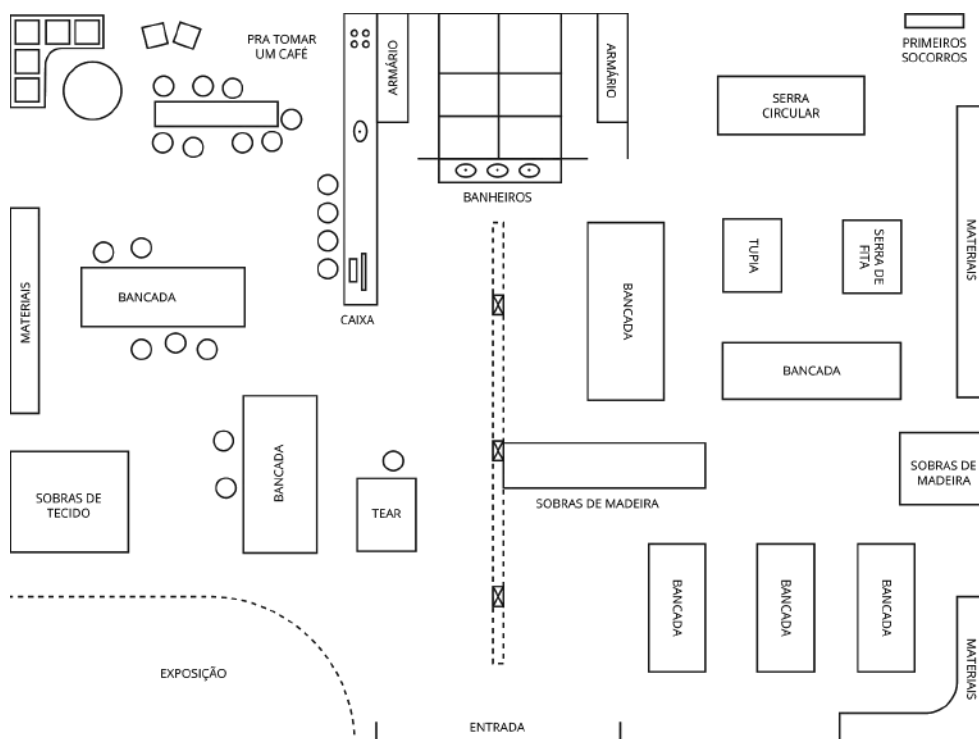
Planta baixa da oficina: proposta de organização do espaço.
